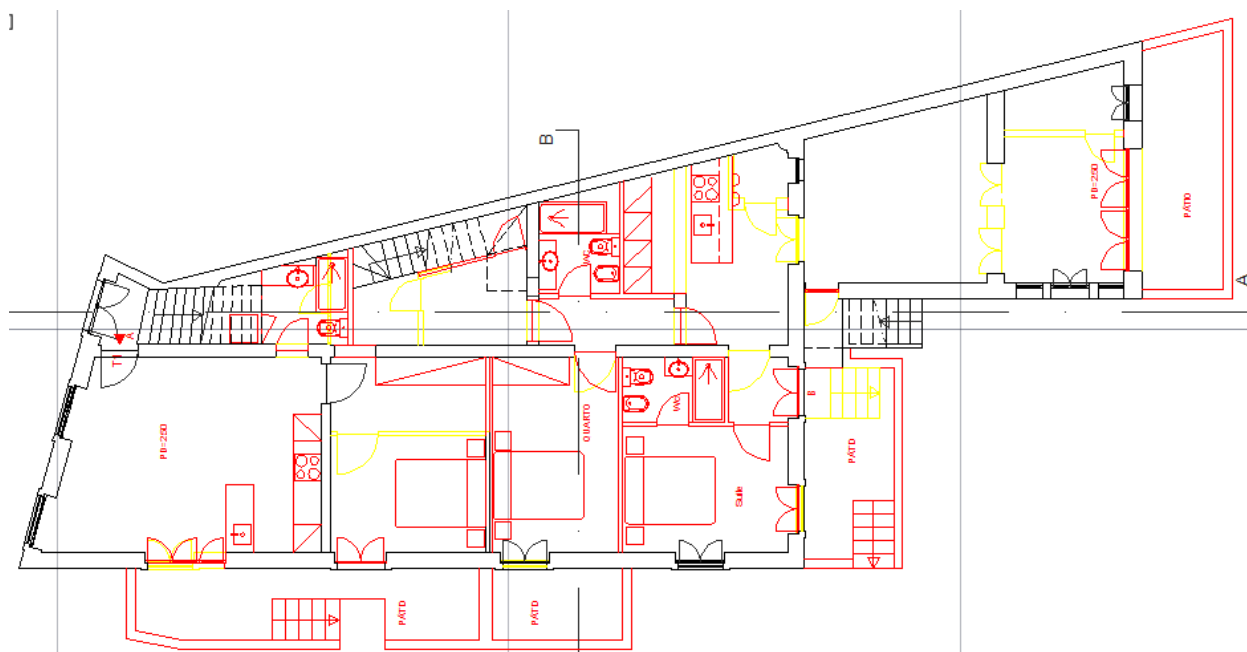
Planta de vermelhos e amarelos do R/C
